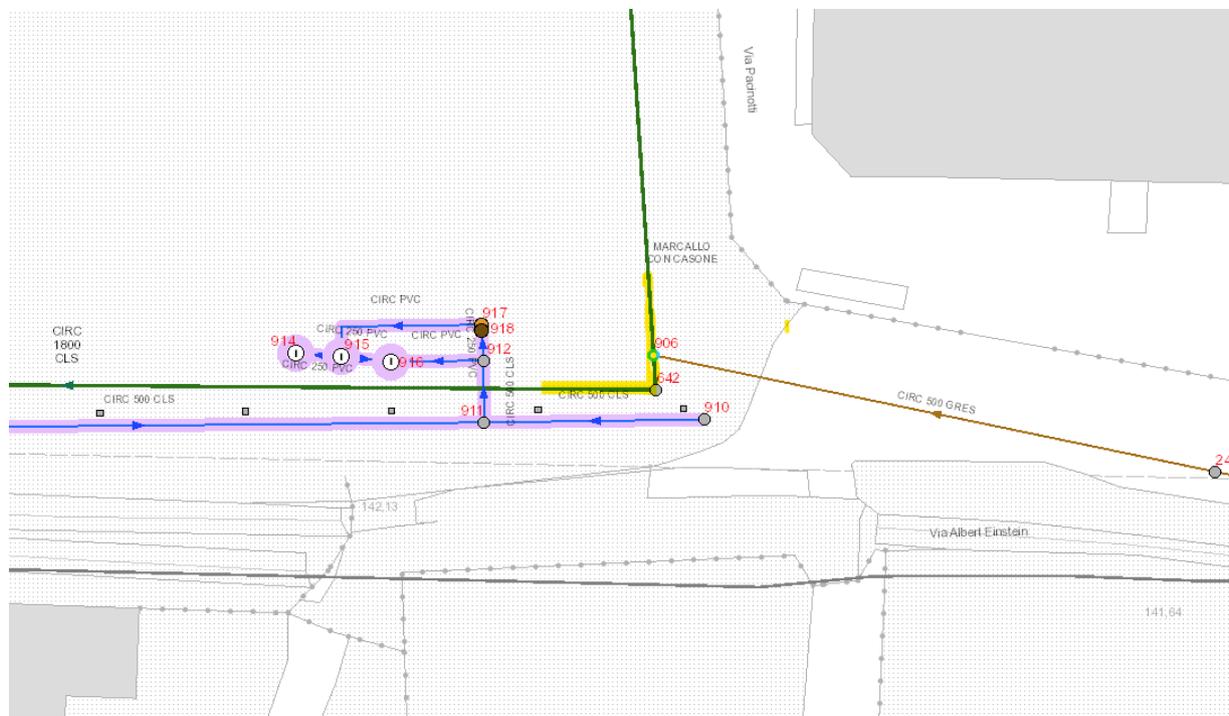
Planimetria rete fognaria – stato di fatto
